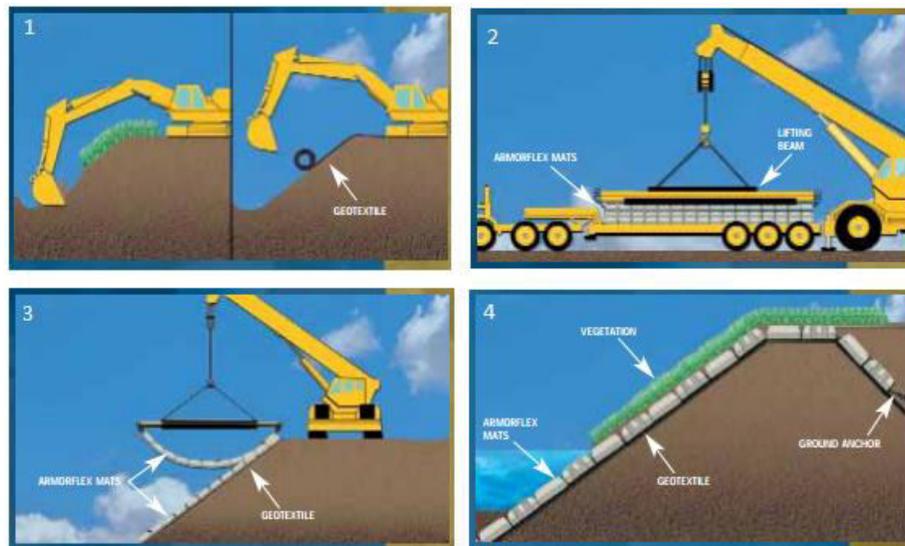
Colocación de las camas de bloques articulados previamente armadas.
